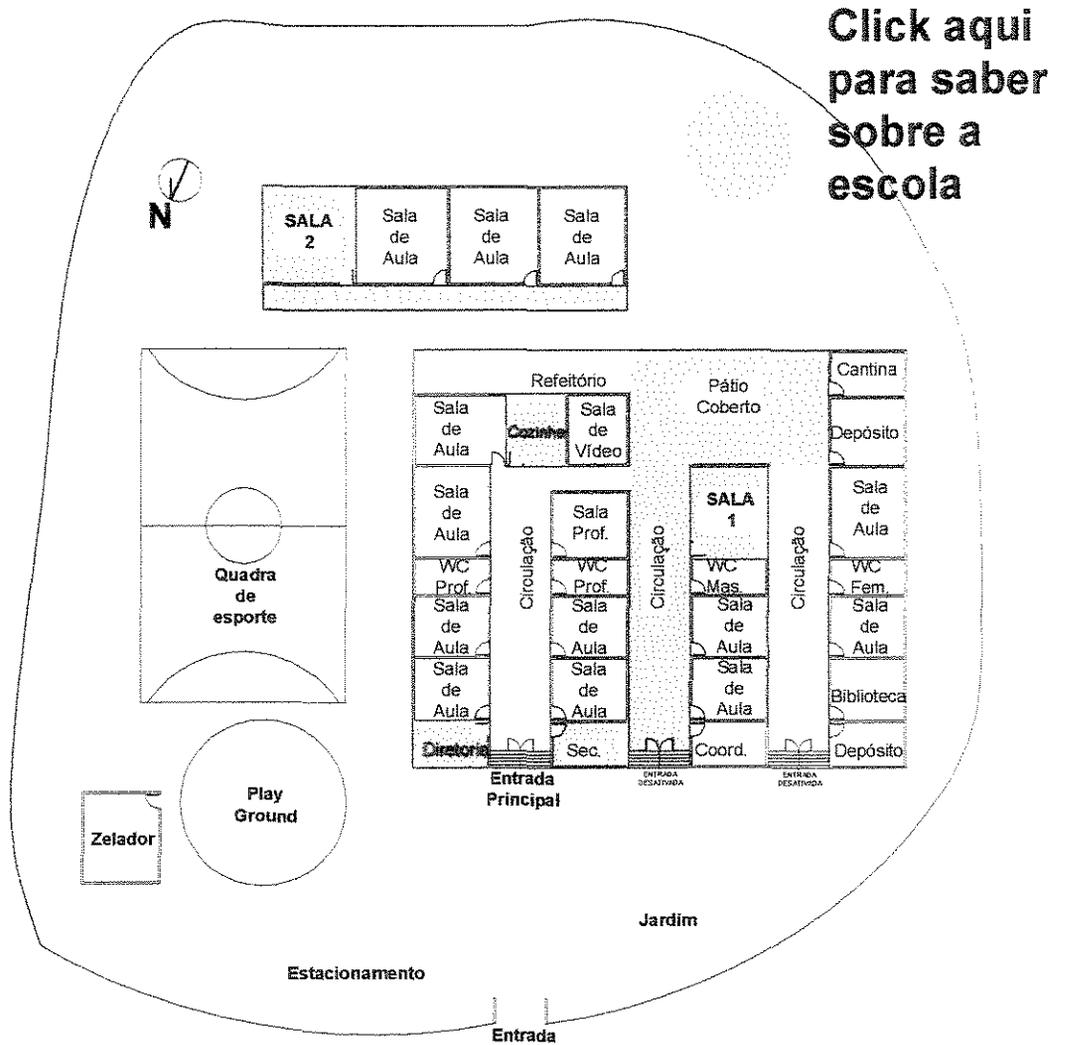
Planta da Escola Armelinda Espúrio da Silva em AutoCAD
